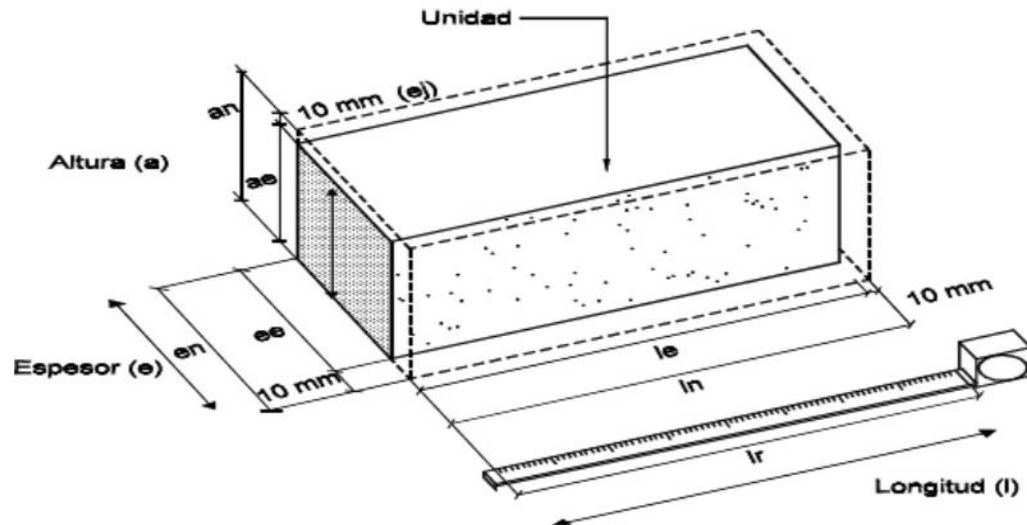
Dimensiones de una unidad de mampostería de concreto.
